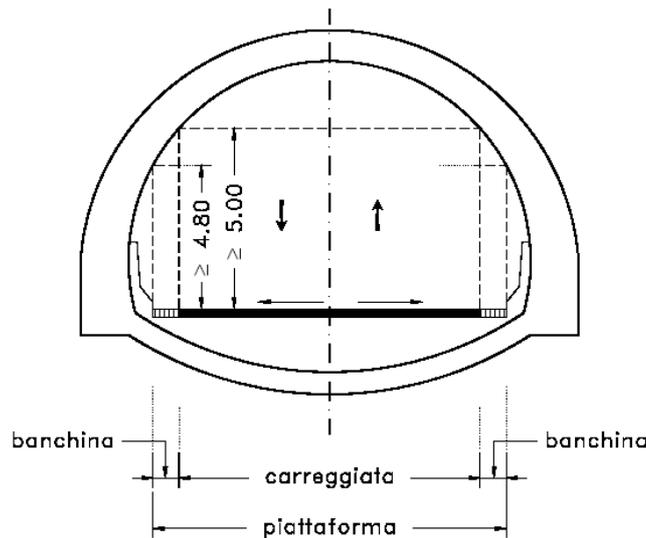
Sezione stradale in galleria delle strade a singola carreggiata.
